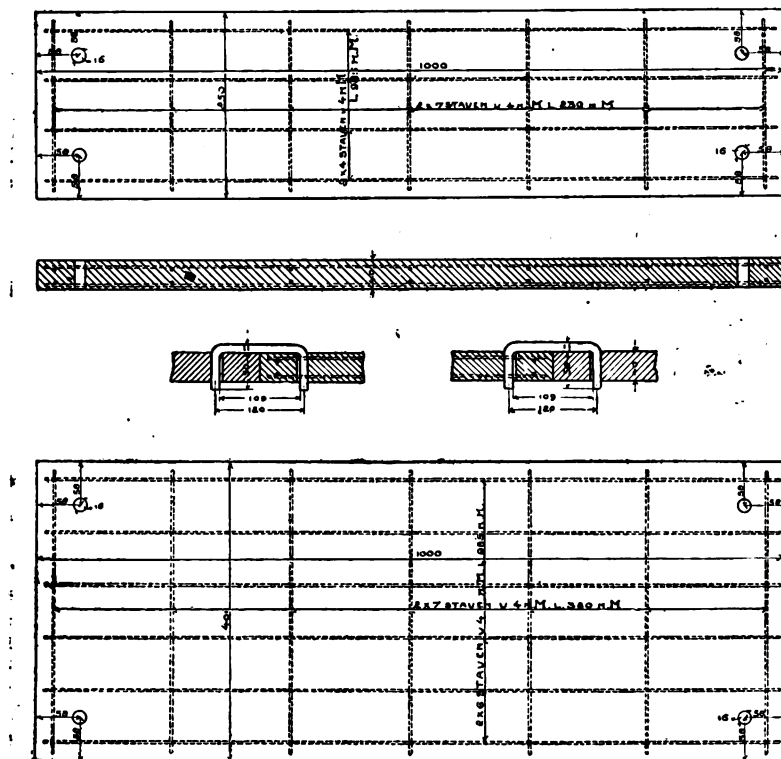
à 5. — Vue en place, coupes et modes d'assemblage des plaques en ciment armé pour la protection des câbles.
